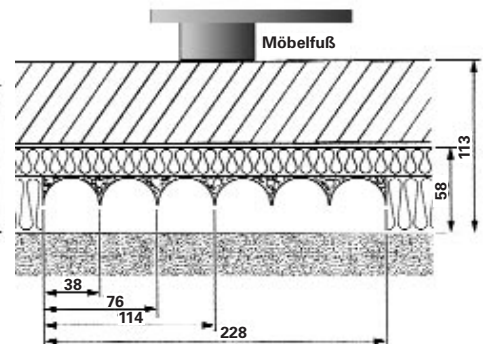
Schaumstoff-Hohlprofile (Rohrdurchmesser 12 mm, Dämmschichtdicke 13 mm)
